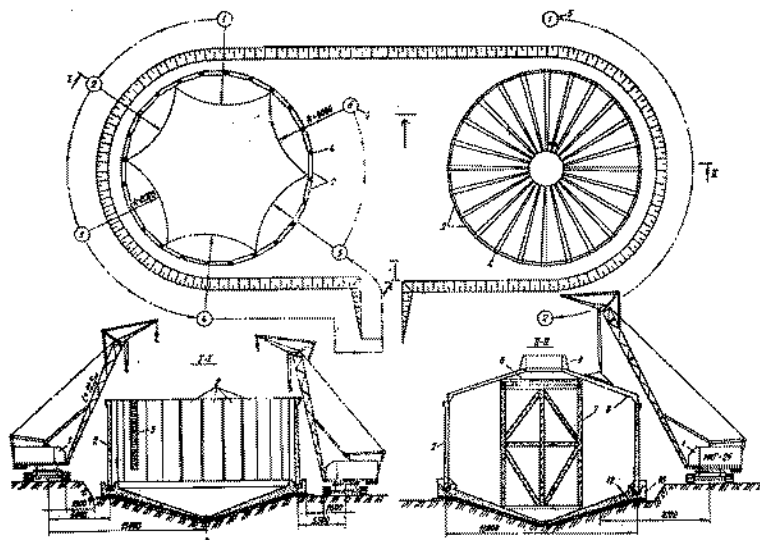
Пример монтажа метантенков диаметром 18 м из типовых плоских панелей гусеничным краном: а - монтаж стеновых панелей; б - монтаж плит покрытия; 1 - монтажный кран; 2 - панели; 3 - инвентарная металлическая лестница; 4 - стыки между сборными конструкциями; 5 - стоянки кранов; 6 - деревянный настил; 7 - трубчатая инвентарная эстакада; 8 - плиты покрытия; 9 - опорное кольцо покрытия; 10 - монолитное днище метантенков с выступами для установки стеновых панелей
